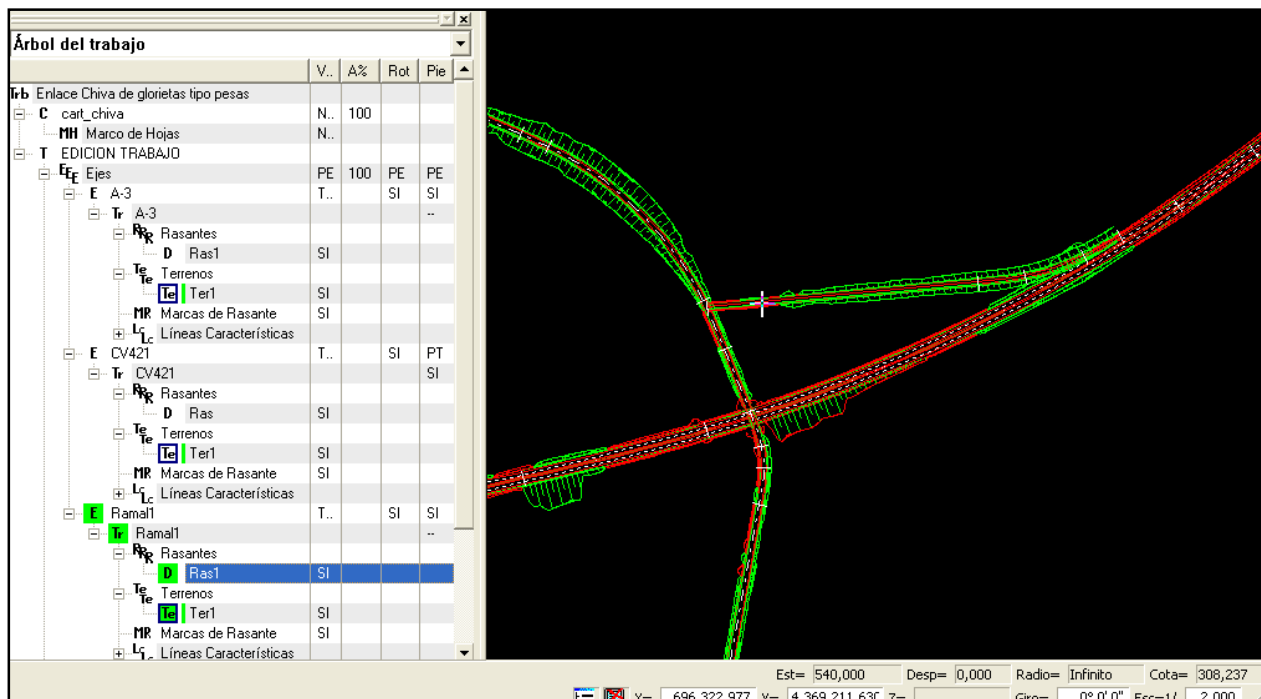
Vista en planta con la definición de anchos y taludes de la CV-421, la autovía y el Ramal 1.
